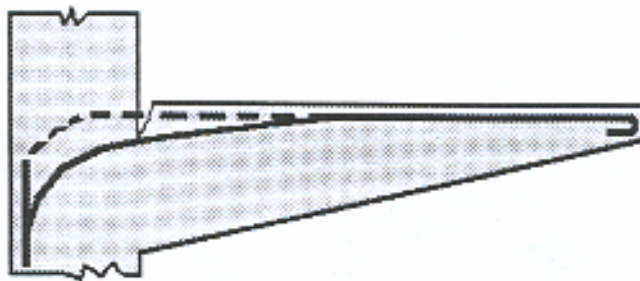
Fissuras causadas por deficiências na confecção
